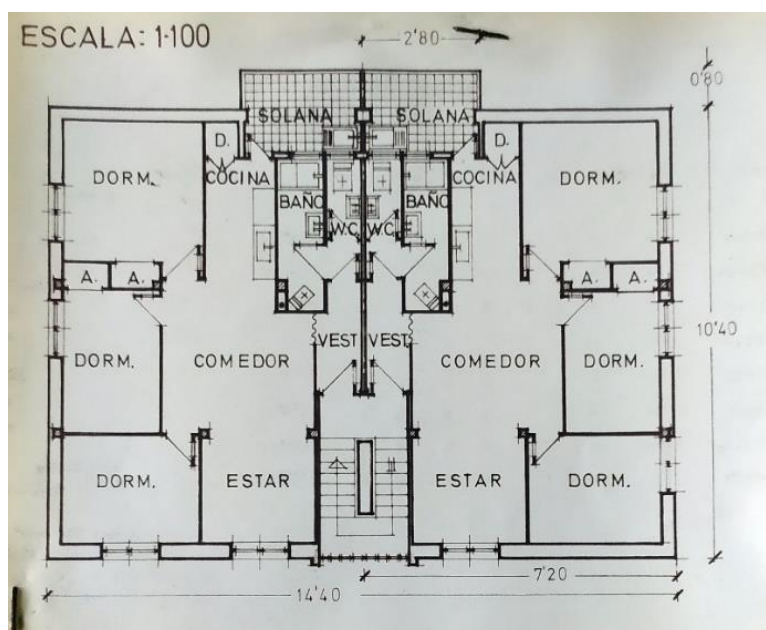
Plano de distribución. [Fuente: Archivo General de la Región de Murcia]
